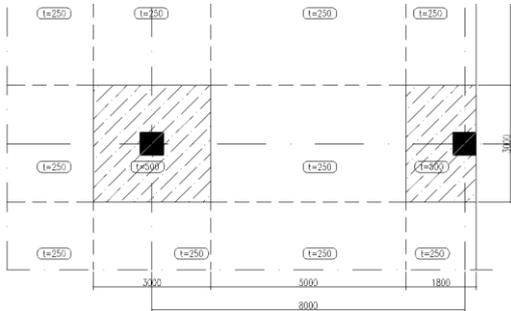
Sistem *Flat Slab* pada Lantai Dasar (PT. Sumaraja Indah, 2016)
